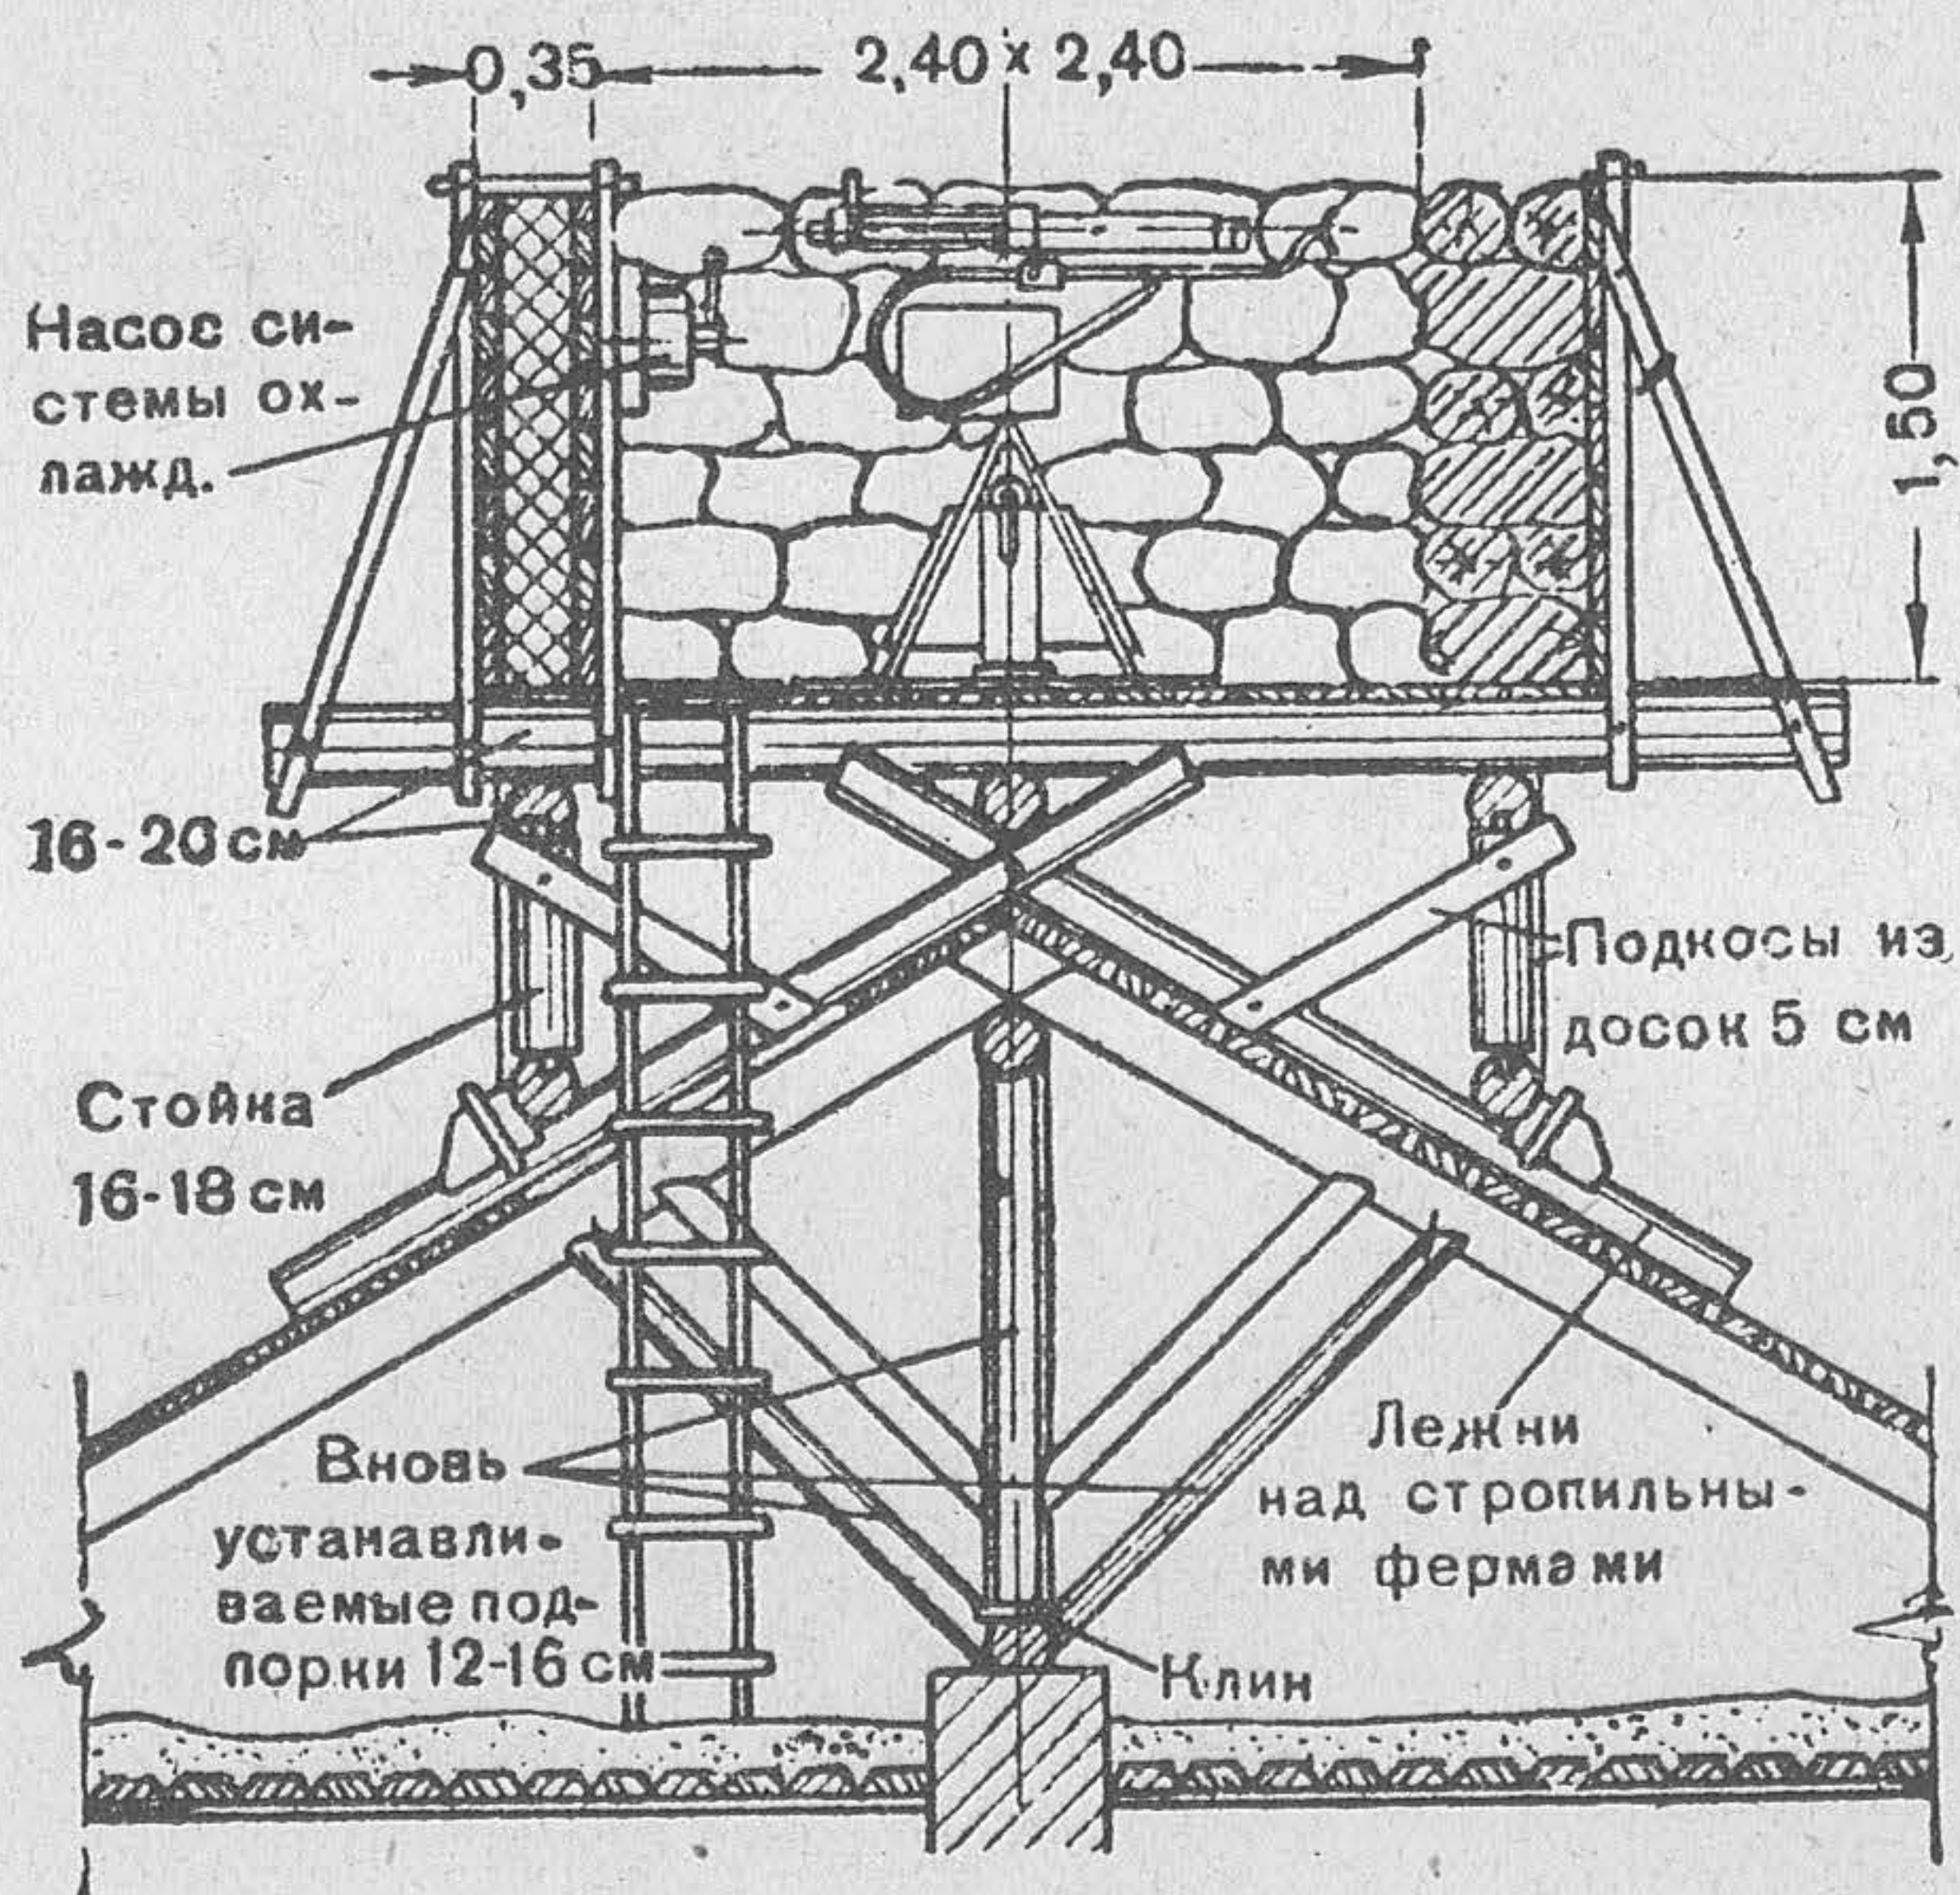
Пулемётная площадка для счетверённой зенитной установки на крыше
